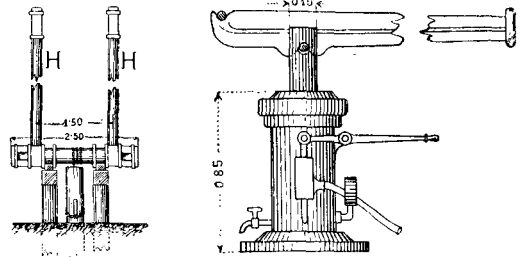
przedstawia przyrząd używany przy budowie portu w Bremie. Łańcuch jest tutaj okręcony na poziomym dębowym wale, który leży tuż za wyciąganym palem i ma z każdej strony po dwa otwory, w kierunku
